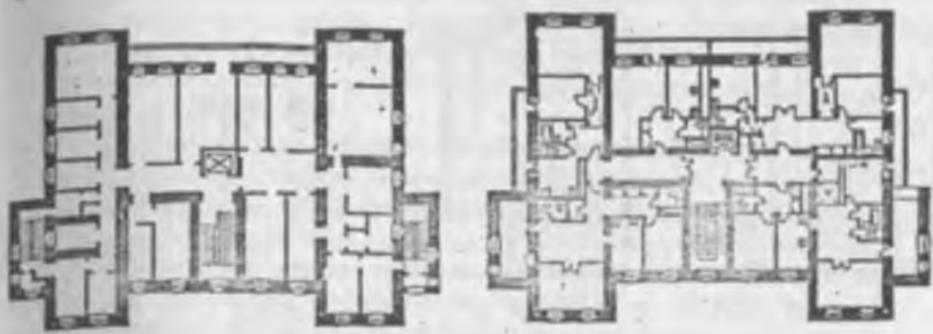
план типового этажа жилого дома по Вишняковскому пер., 23 в Москве до (а) и после (б) реконструкции [11]
